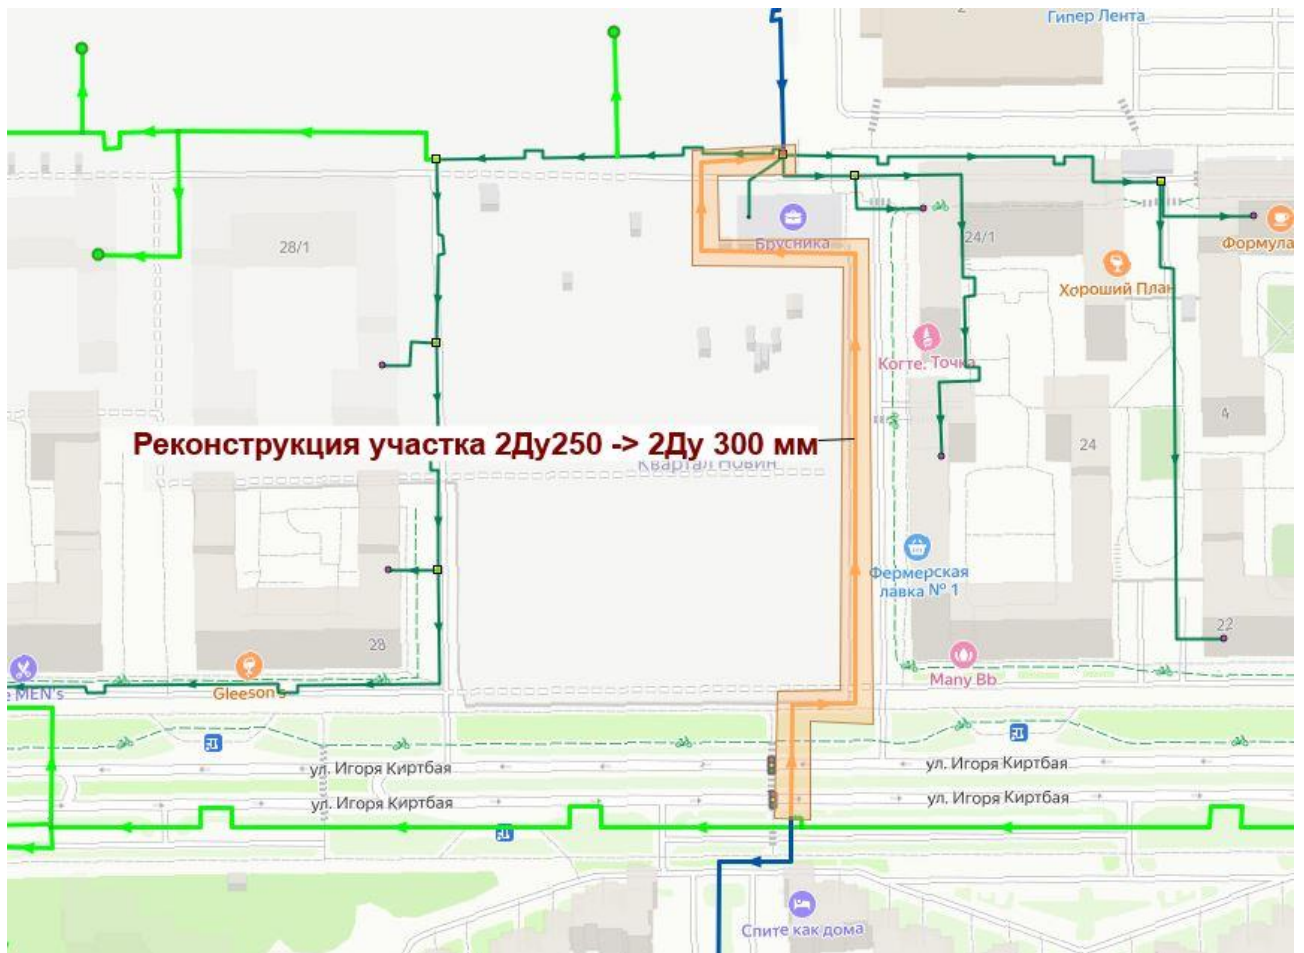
Схема расположения реконструируемого участка от перемычки до УТ-1
